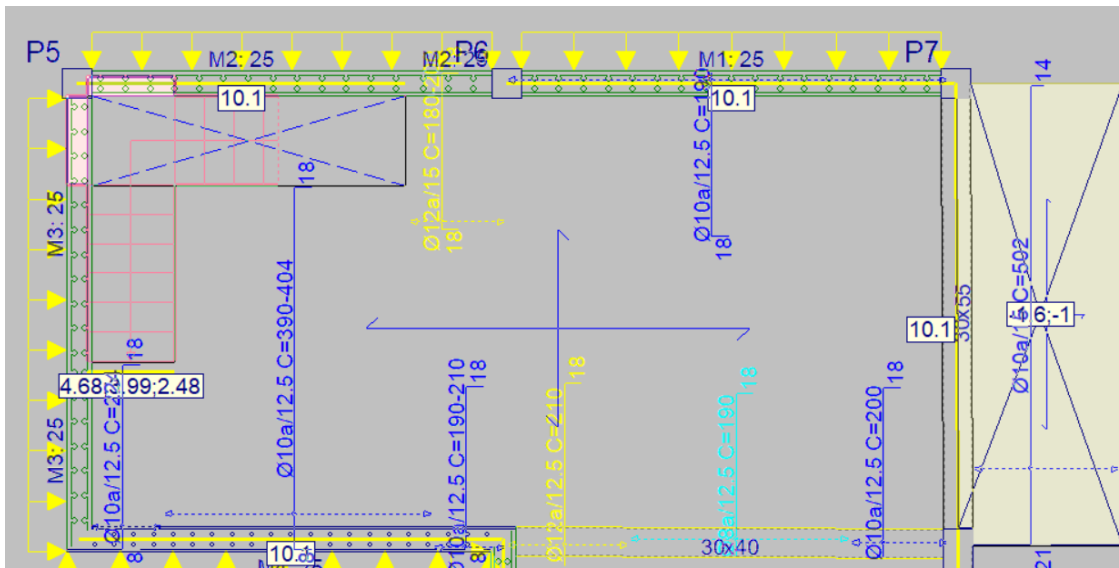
Solução uniformizada para armaduras superiores paralelas ao menor lado da laje
